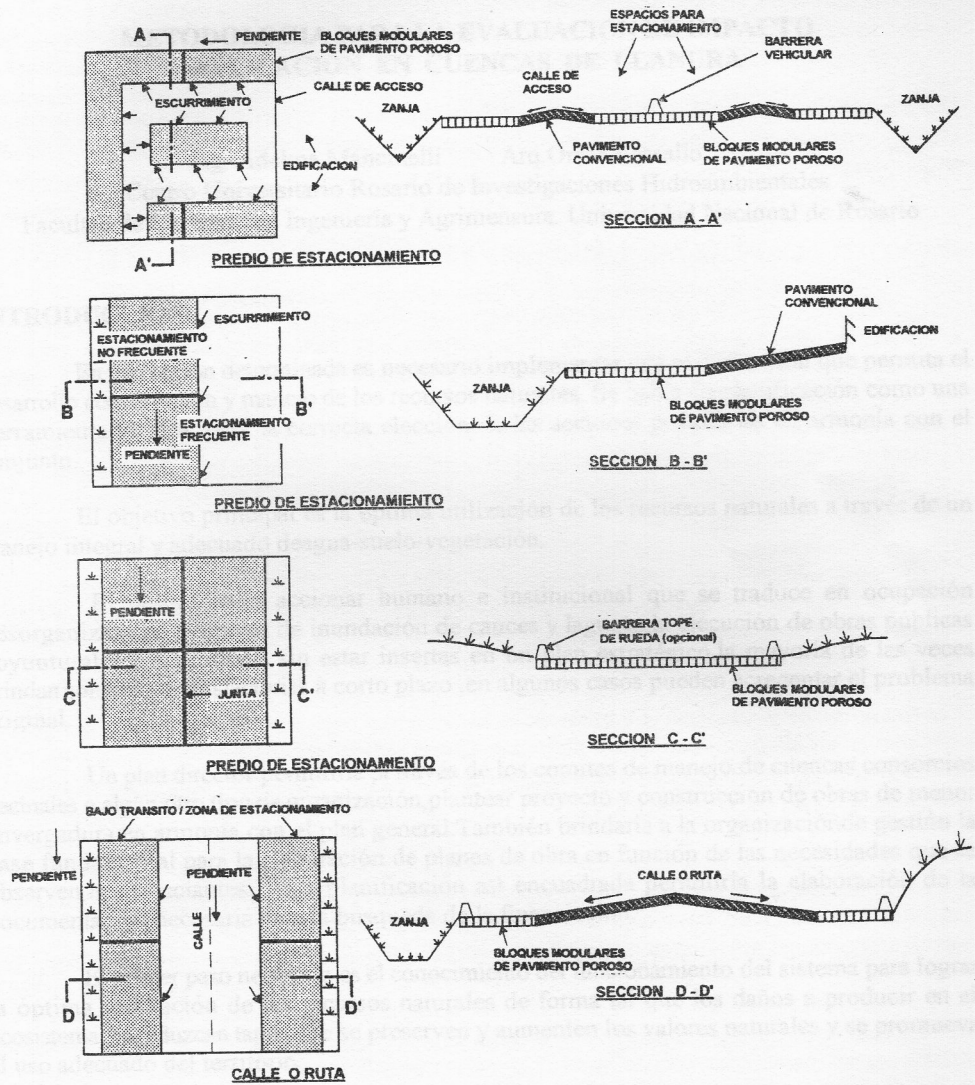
Aplicaciones Típicas de Bloques Modulares de Pavimento Poroso
